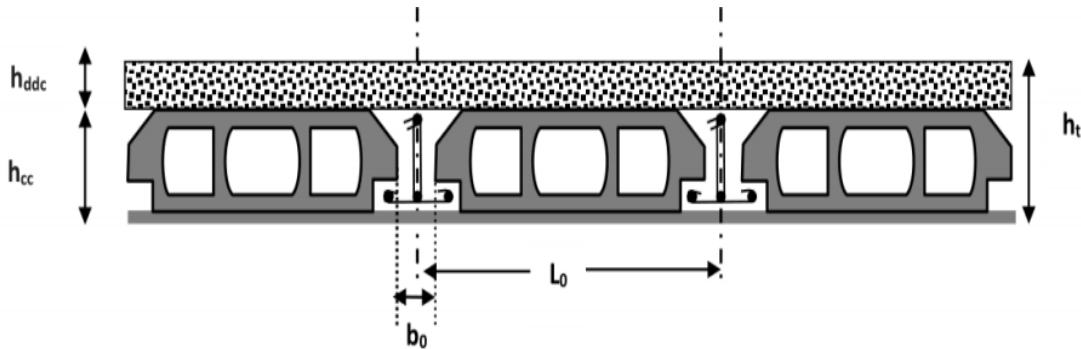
Coupe transversale sur un plancher à corps creux.
